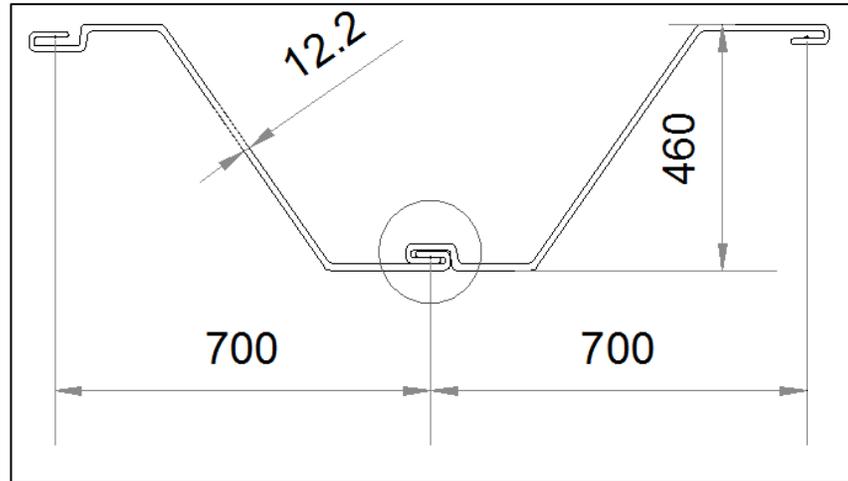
Sección tipo de la tablaestaca propuesta ESC-CRZ26-1400 en la Zona A.
